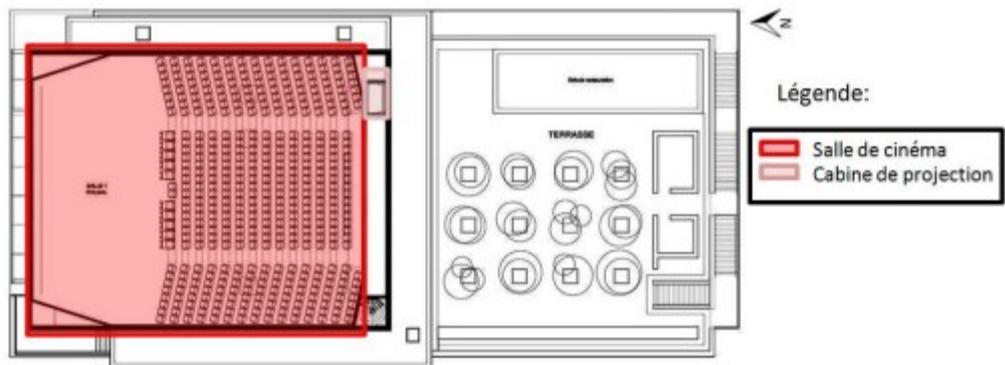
plan niveau salle 4, 5, 6, 7. De 1er étage.
